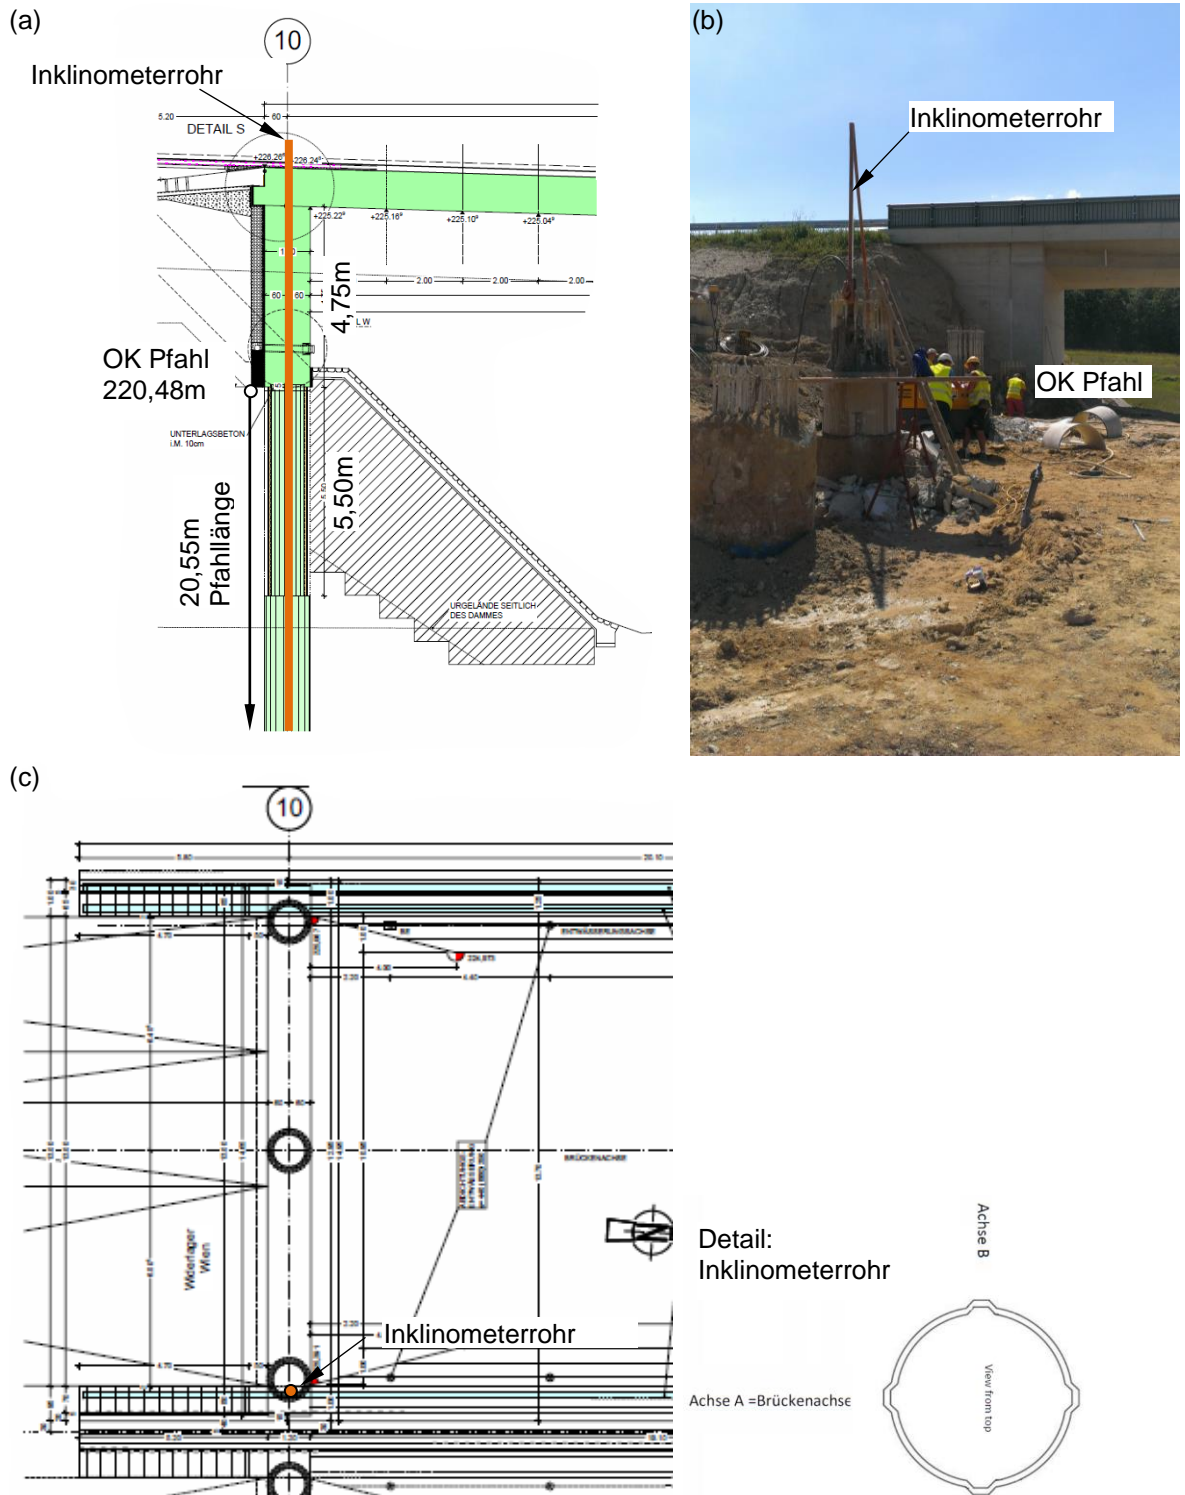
(a) Führung Inklinometerkur Achse 10, RFB Wien im Schnitt, (b) Detail beim Einbau Inklinomet und verpressen mit dem Stahlrohr in der Pfahlbewehrung und (c) Lage im Grundriss.
